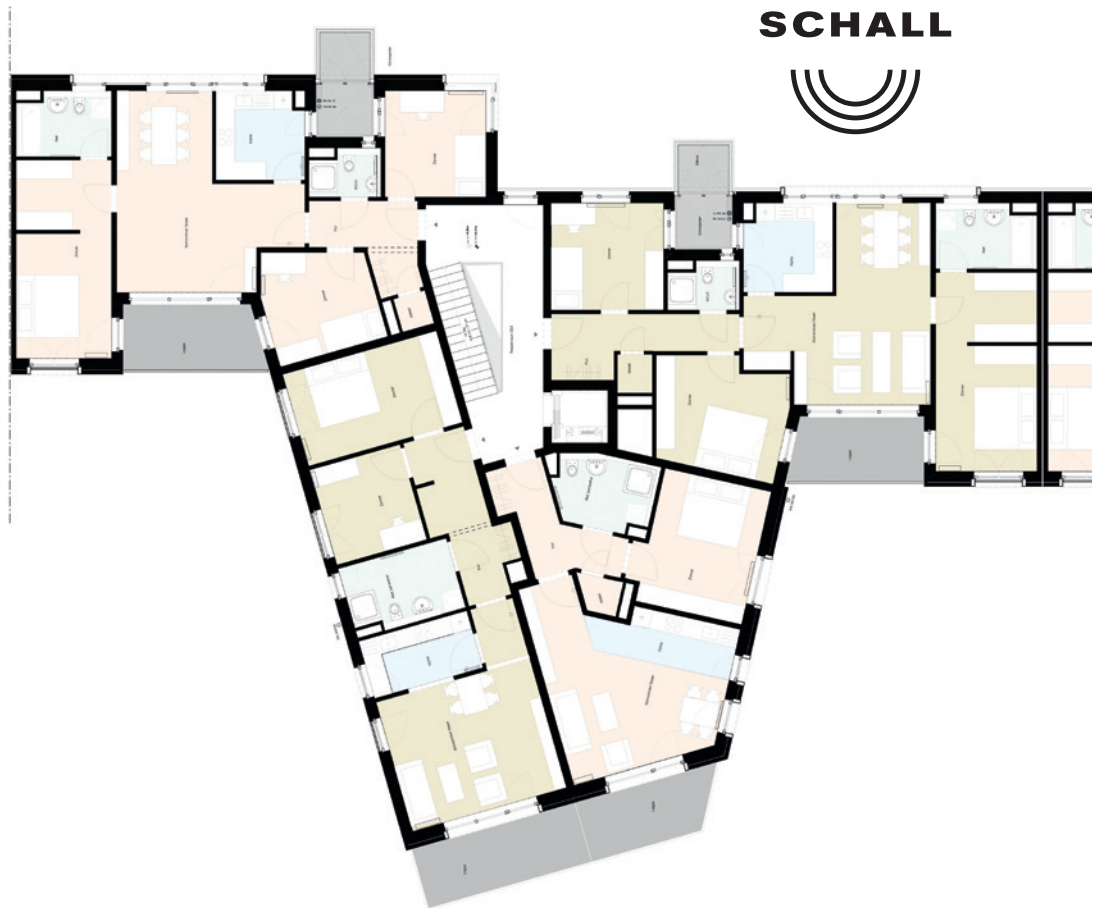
Grundrissentwurf LRW Architekten und Stadtplaner, Loosen, Rüschoff + Winkler – Bauvorhaben in Lokstedt
